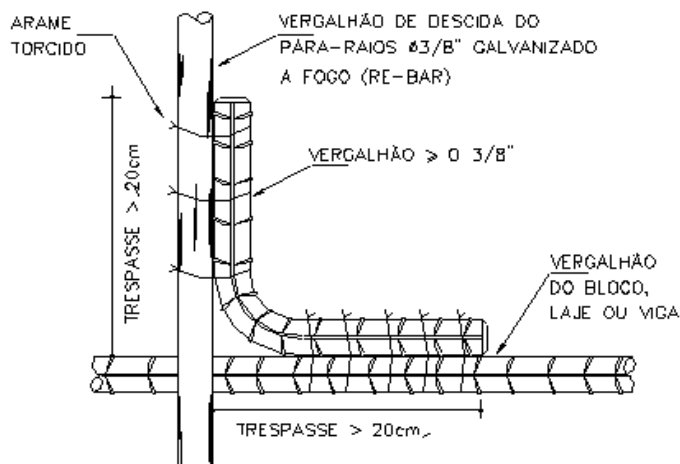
Amarração do vergalhão do para-raios com outras ferragens próximas
